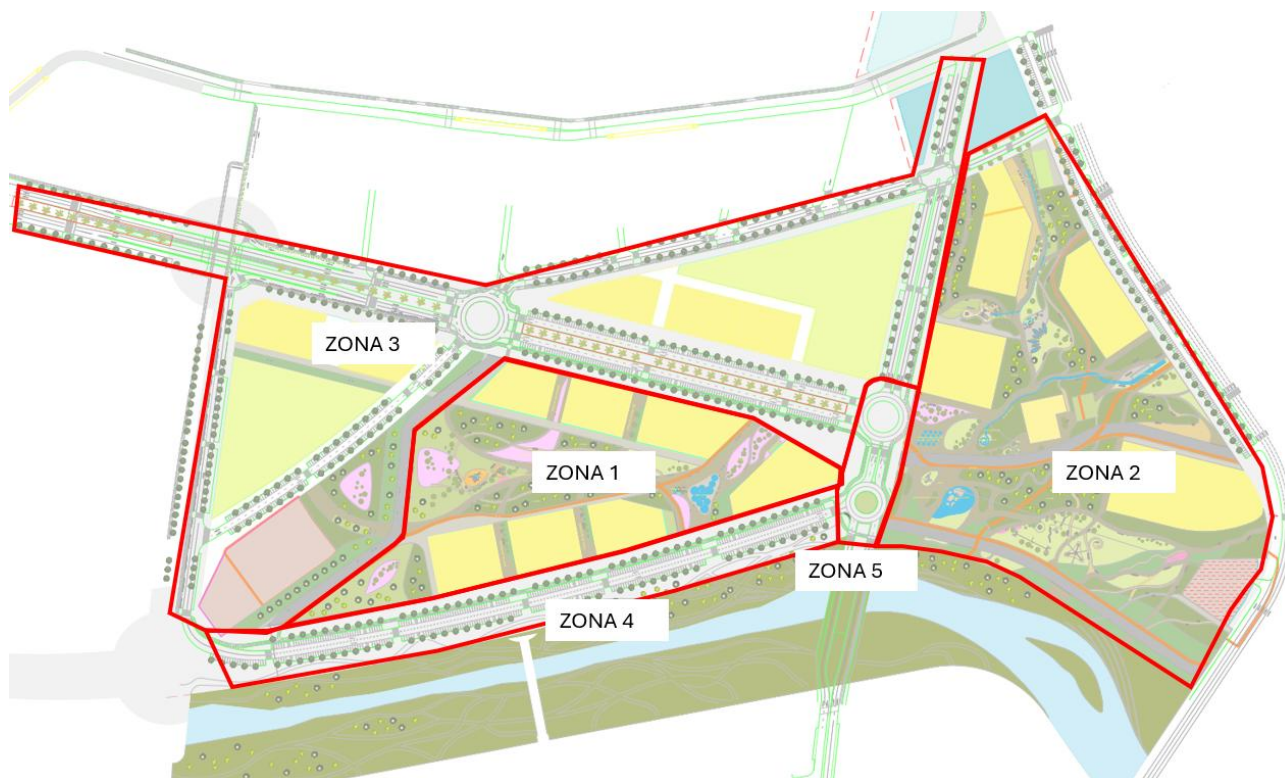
Distribución de zonas con aplicación de drenaje convencional y drenaje sostenible.
